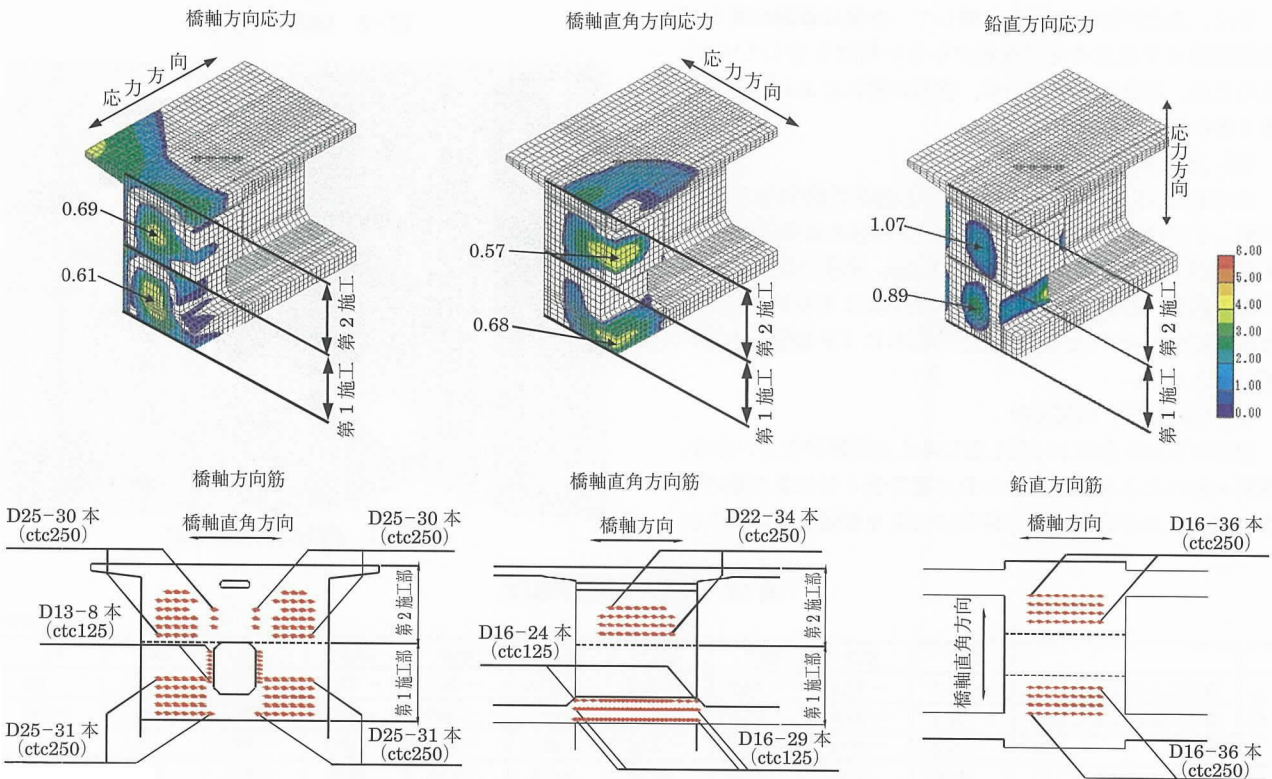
ひび割れ指数コンター図および補強鉄筋の配置
